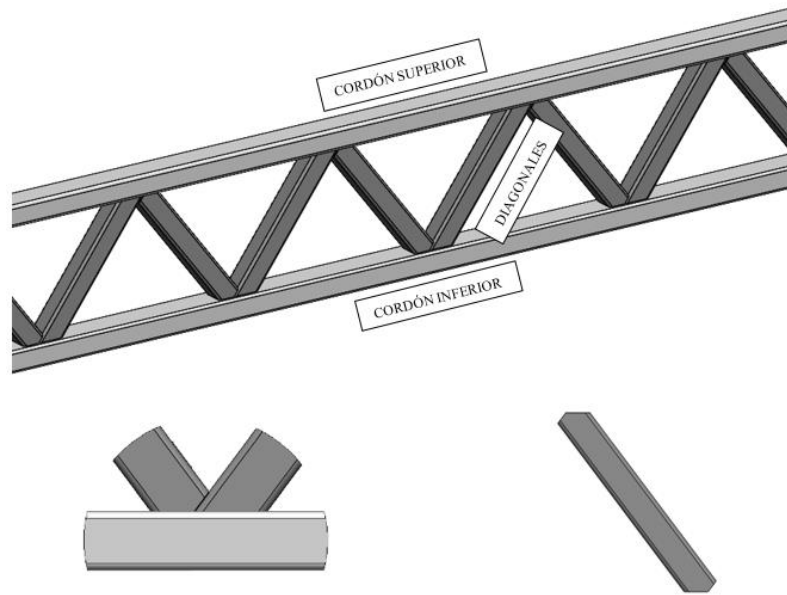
Armadura con uniones en K traslapadas y detalles.
